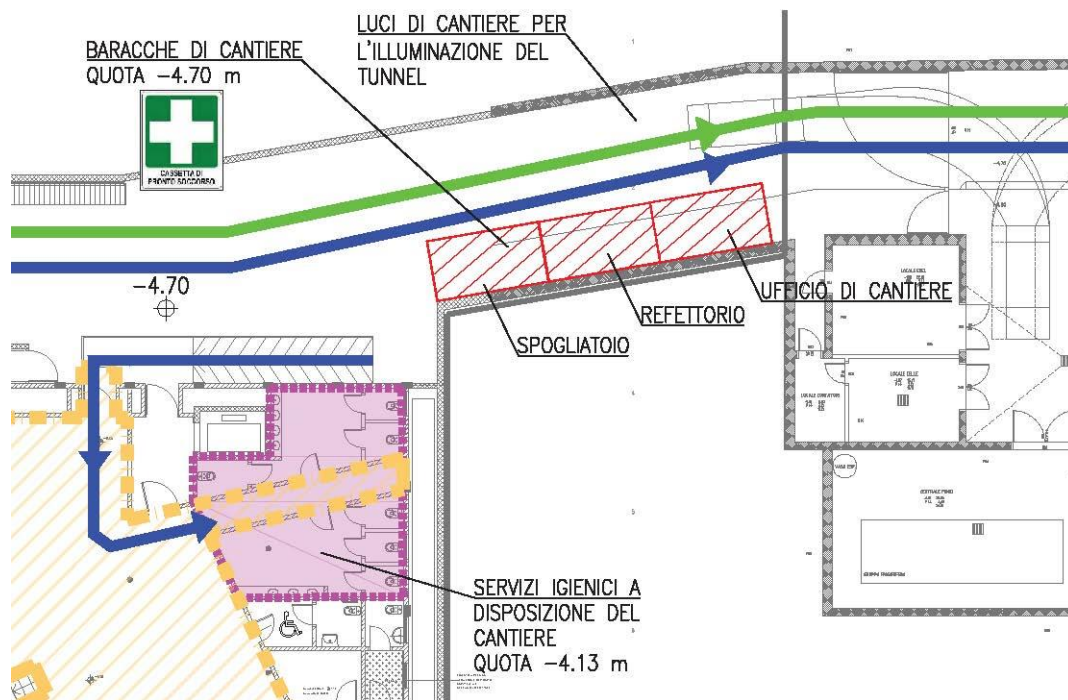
Aree di cantiere fissa con individuazione delle baracche e dei servizi igienici a disposizione del cantiere.
